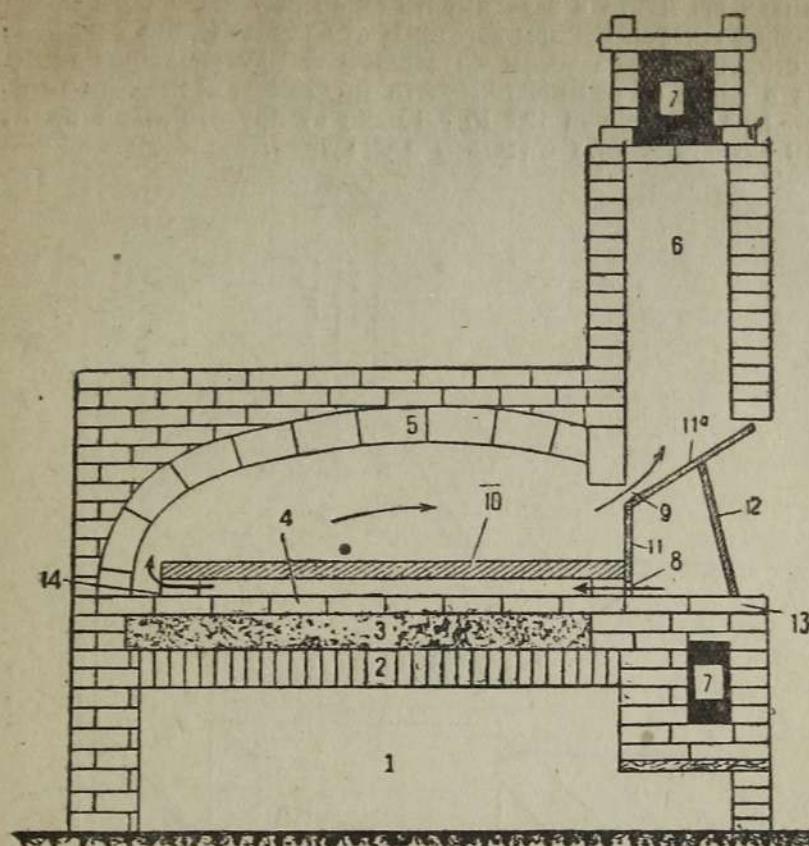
Продольный разрез русской печи и приспособление проф. Киттари (заслонка с козырьком): 1—подпечье; 2—свод подпечья; 3—песок; 4—под печи; 5—свод печи; 6—чело; 7—дымоход; 8—нижняя щель (для притока воздуха); 9—верхняя щель (для вытяжки воздуха); 10—сито; 11—заслонка (из жести или тонкого теса); 11а „коzyрек“ к заслонке; 12—подставка заслонки; 13—шесток; 14—кирпичи (подставка) под сита.
